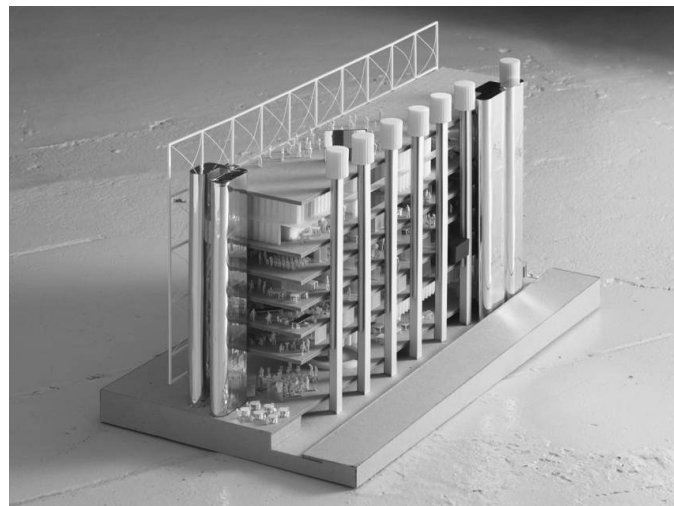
Nordfassade - vorgefertigte Stahlbetonstützen (T-Form)
